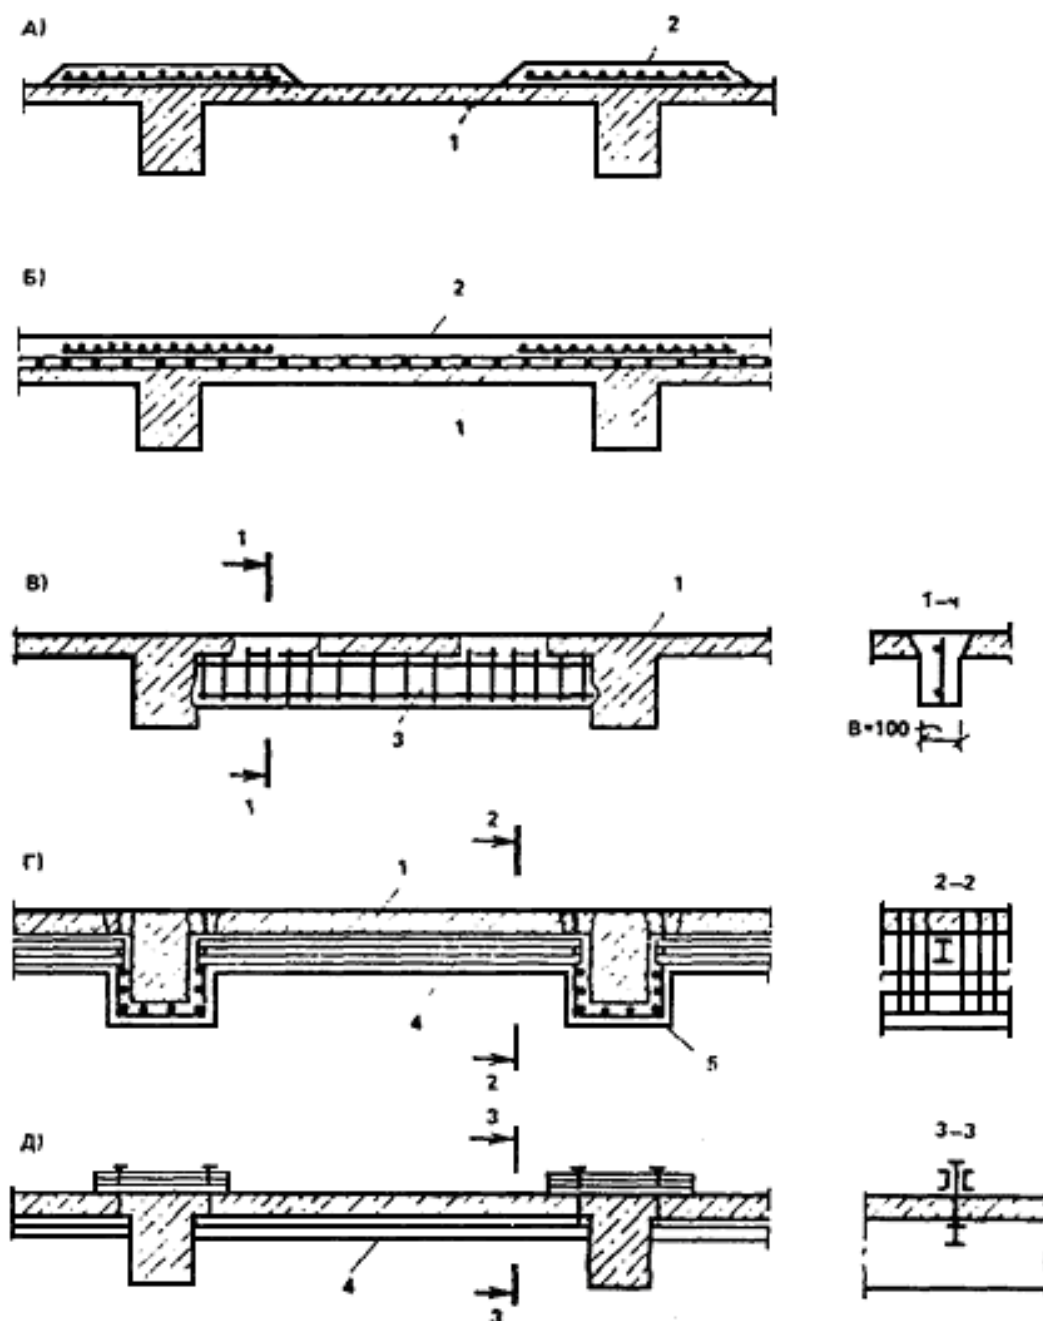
Усиление плит железобетонных монолитных перекрытий
